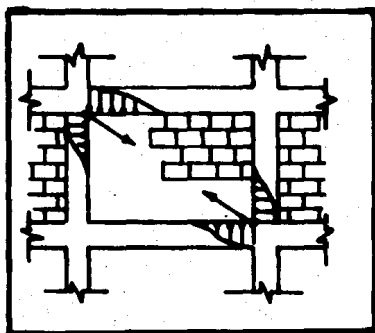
(9) Malla por Elementos muy rígidos.
